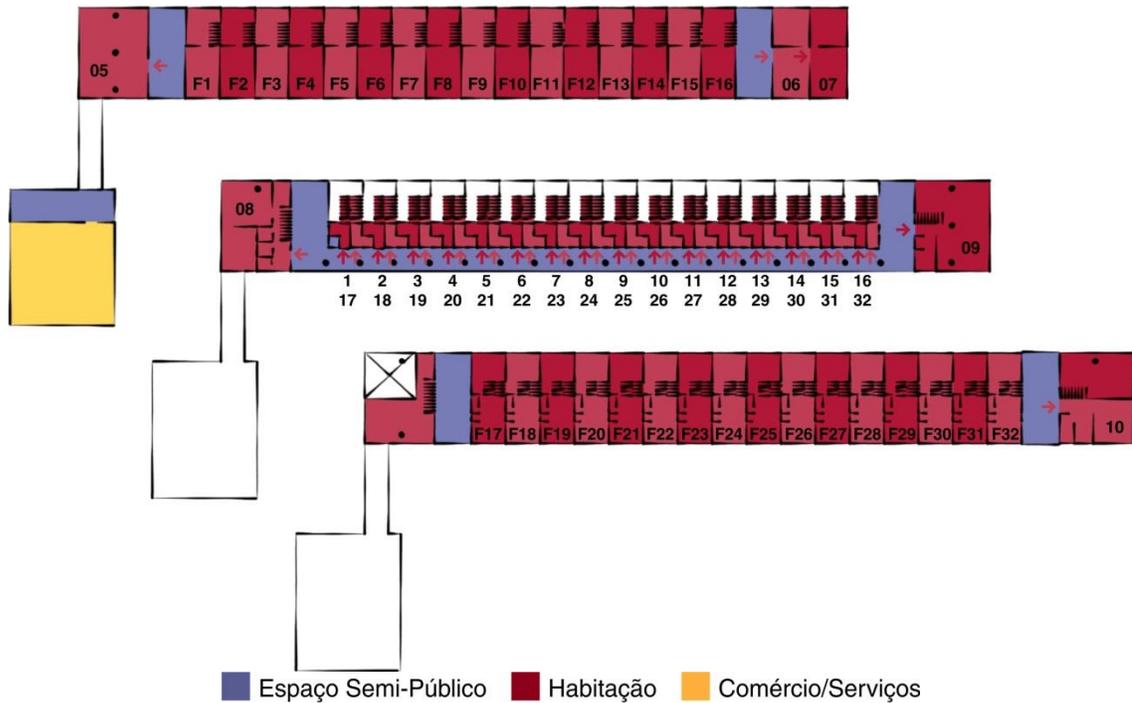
| Narkomfin - Diagramas plantas 3º, 4º e 5º pavimentos | Desenho da Autora
